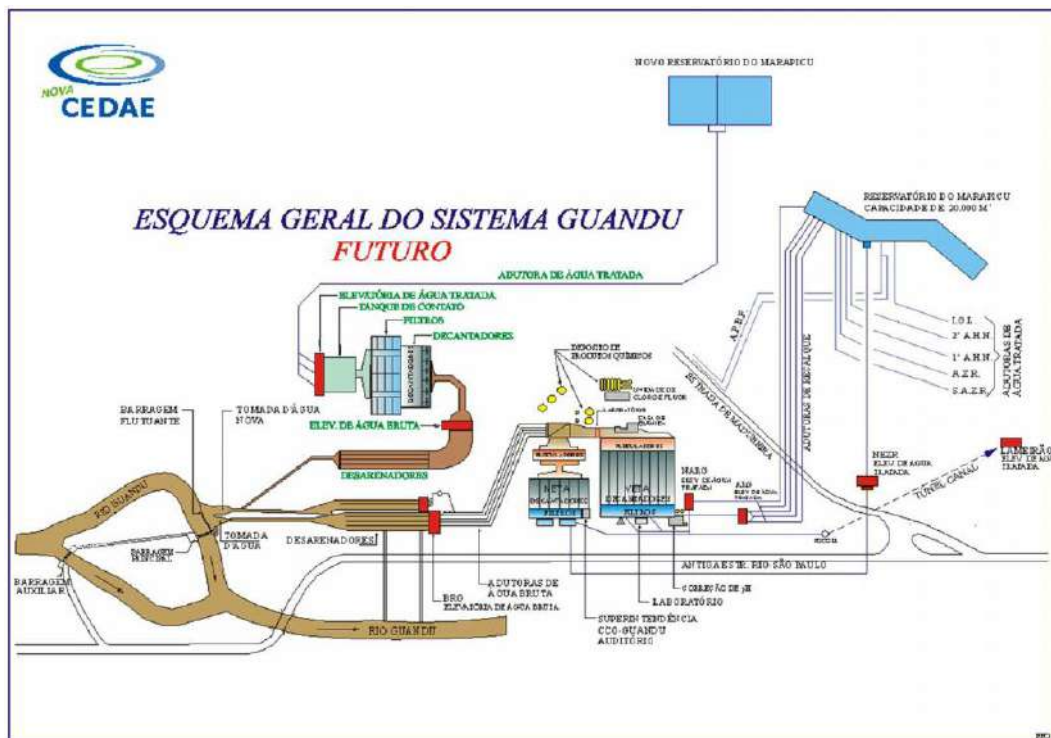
Planta esquemática da expansão futura da ETA-Guandu.
